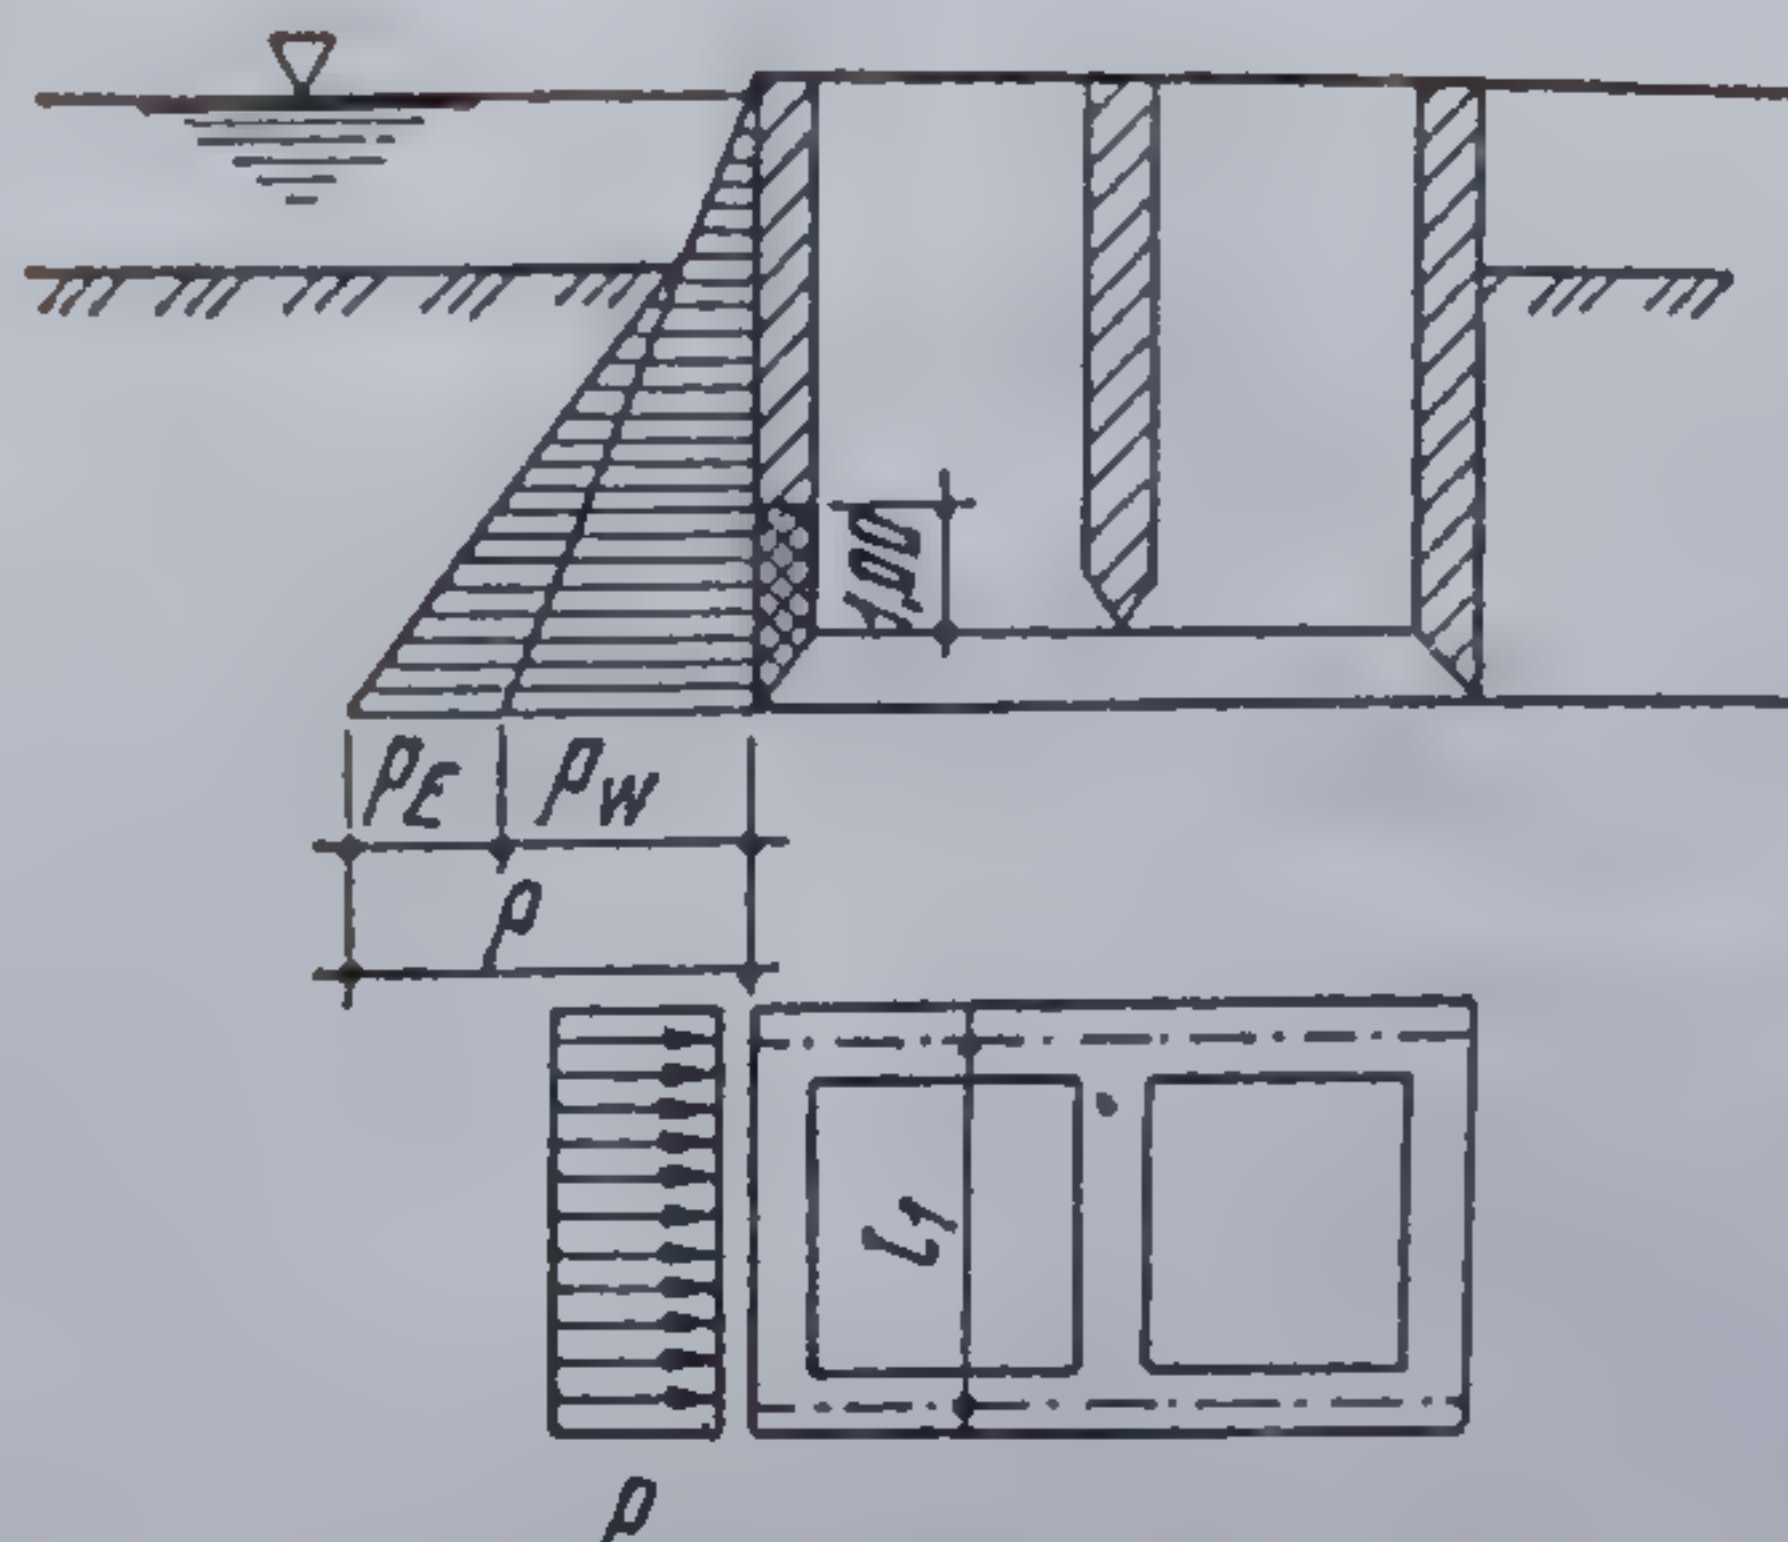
Schema de calcul al pereților în plan orizontal.
